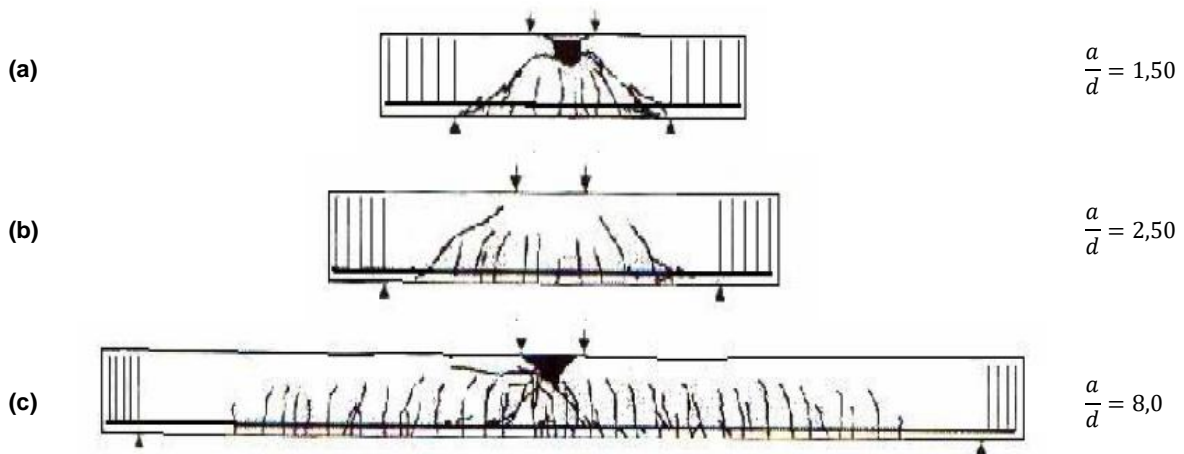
a) Ruptura causada pelo esmagamento do concreto da alma; b) Ruptura por cisalhamento; c) Ruptura por flexão, com fissuras perpendiculares ao eixo do elemento estrutural (adaptado Menon, 2008).
